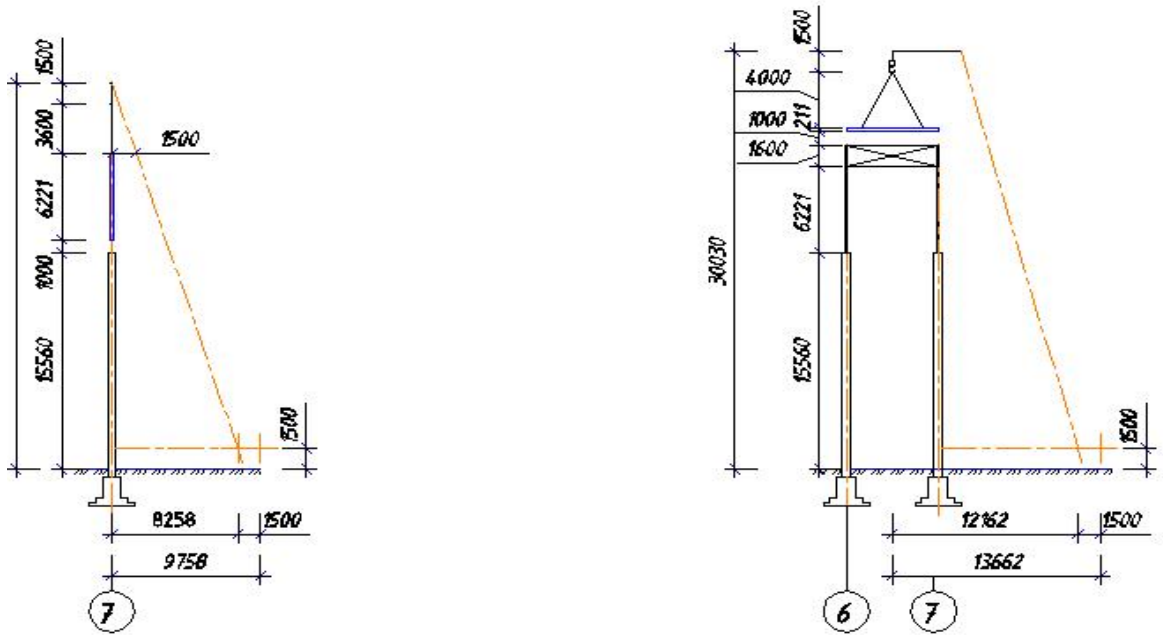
Требуемые параметры крана при монтаже деревянных конструкций покрытия
